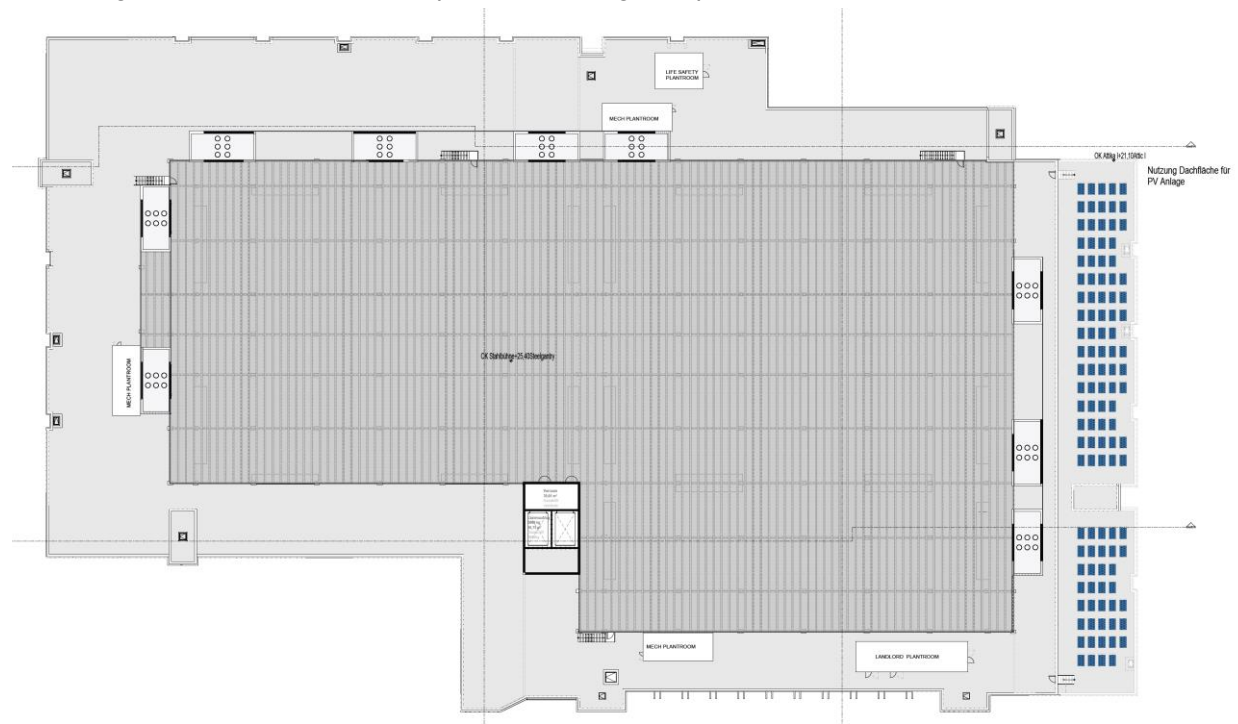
Lageplan Dach im Endzustand (Quelle: Planungsbüro).
